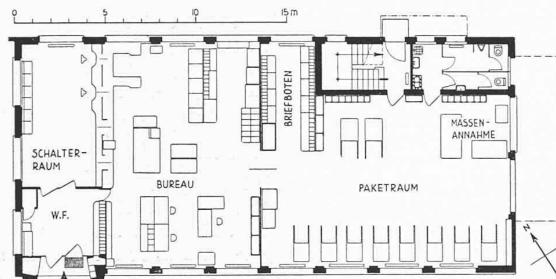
Postgebäude Wallisellen, Erdgeschoss 1:400
